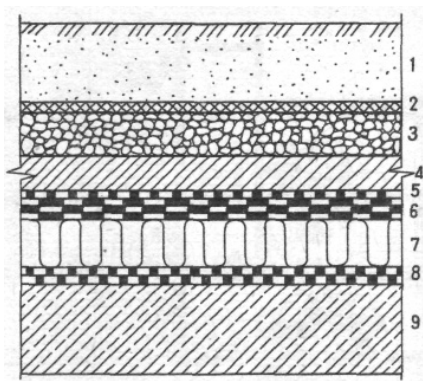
Пример конструкции крыши-сада: 1 — растительный грунт; 2 — фильтрующий слой; 3 — дренажный слой; 4 — защитный слой; 5 — разделительный слой; 6 — гидроизоляция; 7 — утеплитель; 8 — выравнивающий слой и пароизоляция; 9 — несущая конструкция
